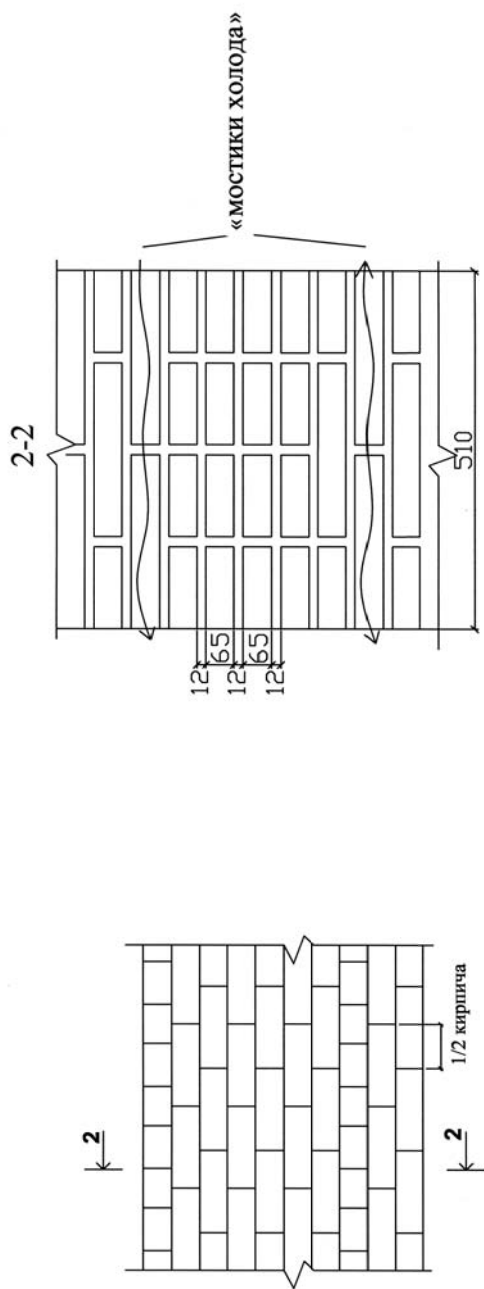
Многорядная перевязка кладки стен (из кирпича толщиной 65 мм) толщиной в два кирпича
